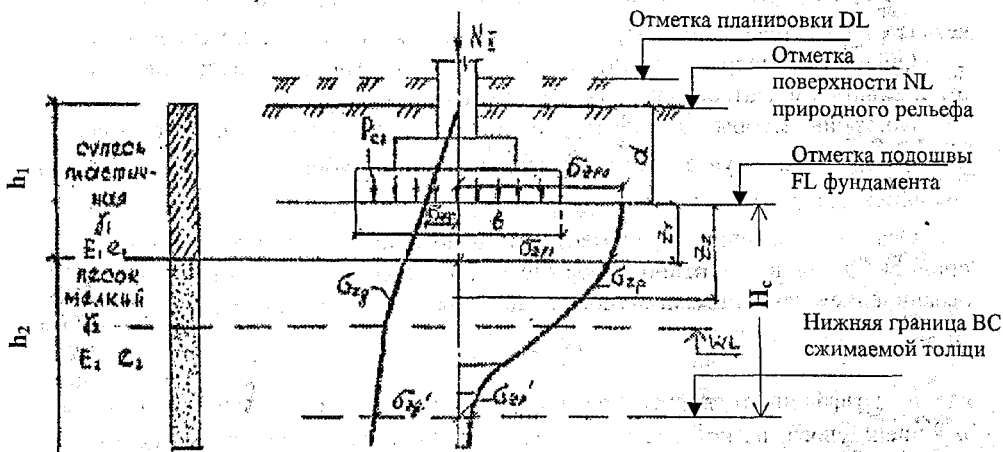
Схема к расчету осадок методом послойного суммирования
